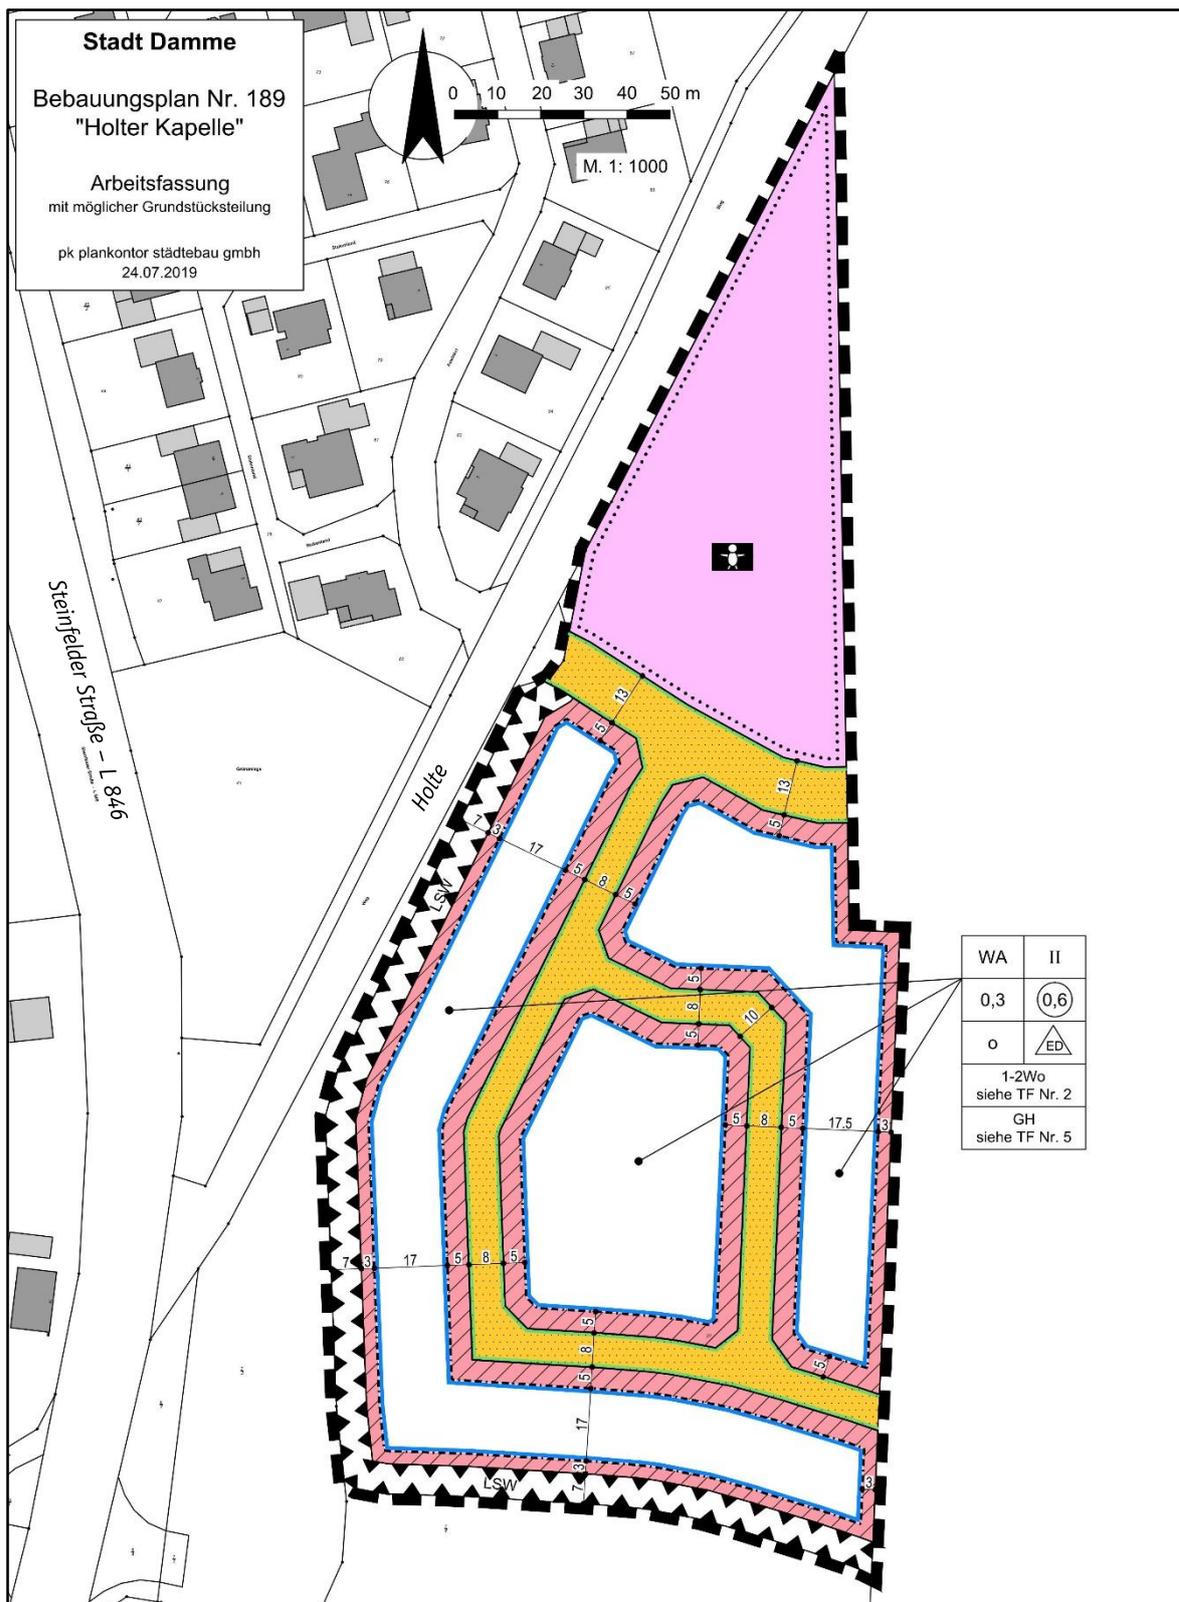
Lageplan mit dem Plangebiet. Quelle: [9].
